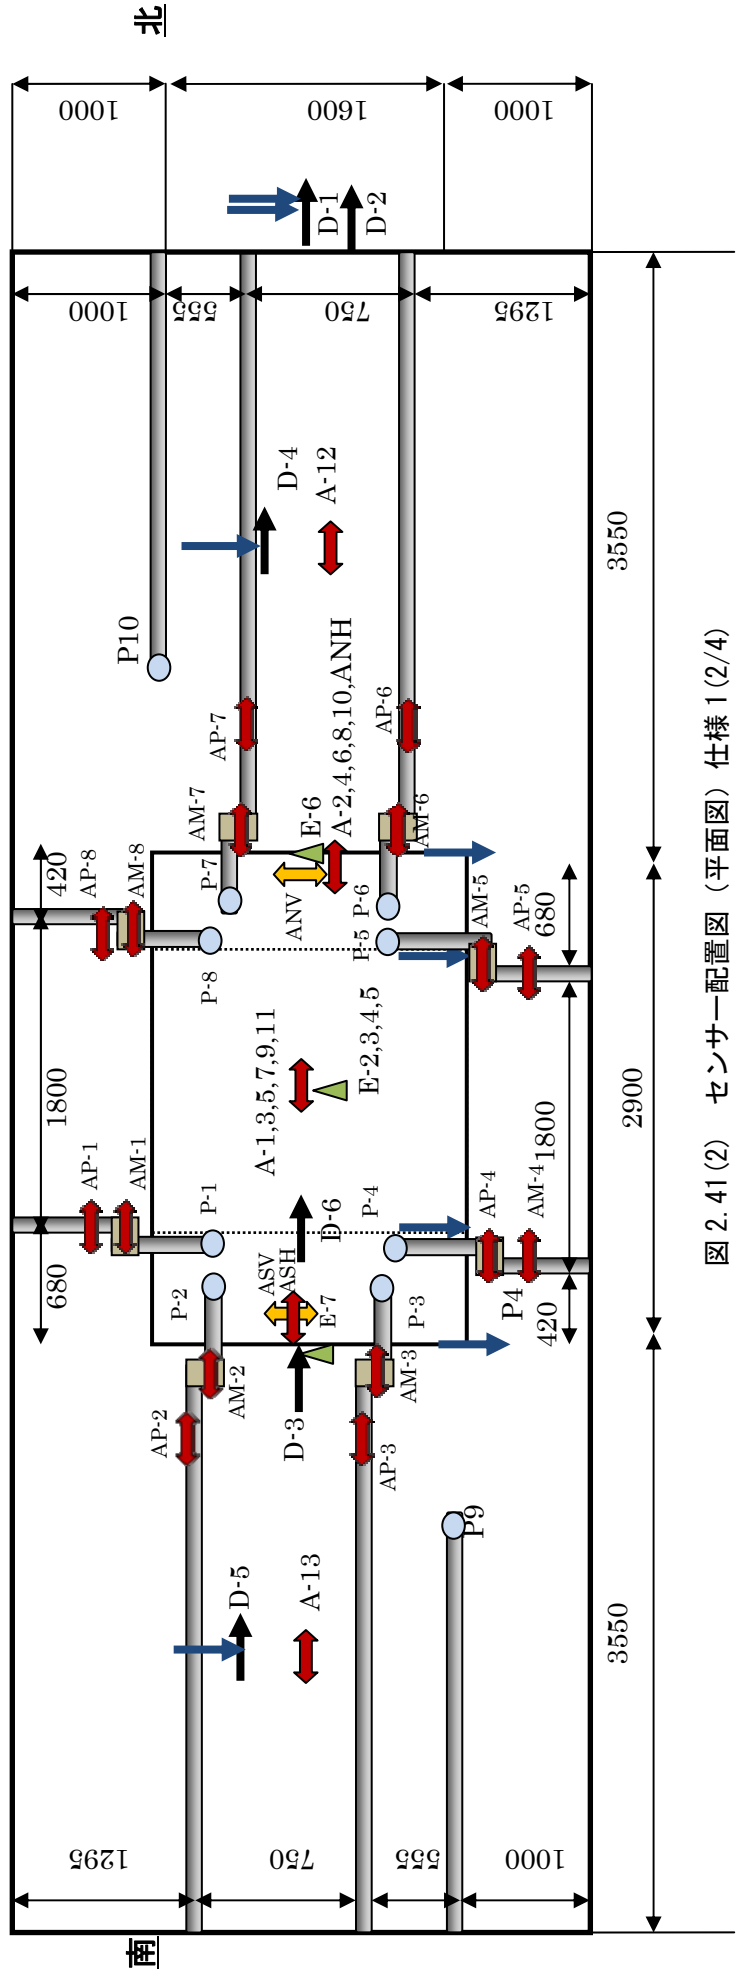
(2) センサー配置図 (平面図) 仕様 1(2/4)
